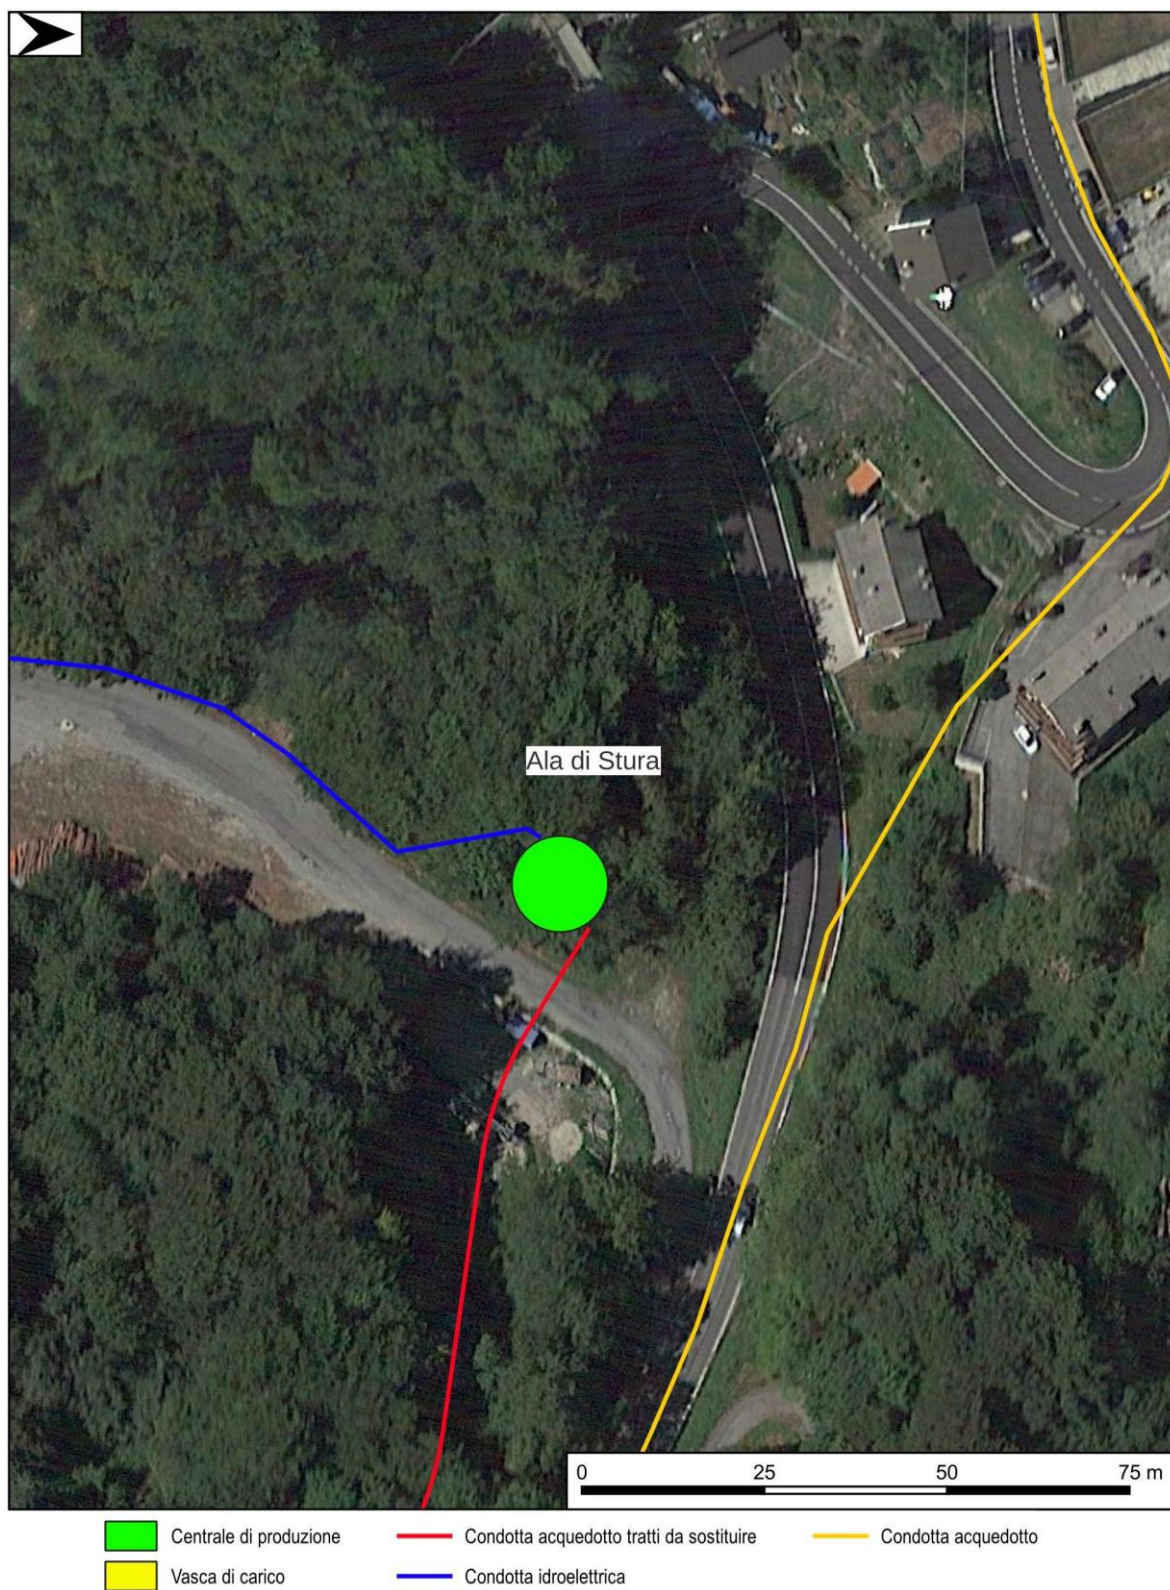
Planimetria delle attività in progetto – Dettaglio Area Centrale di Produzione
